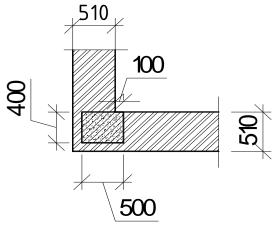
Предлагаемое расположение железобетонной колонны в теле стены на Г-образном пересечении
